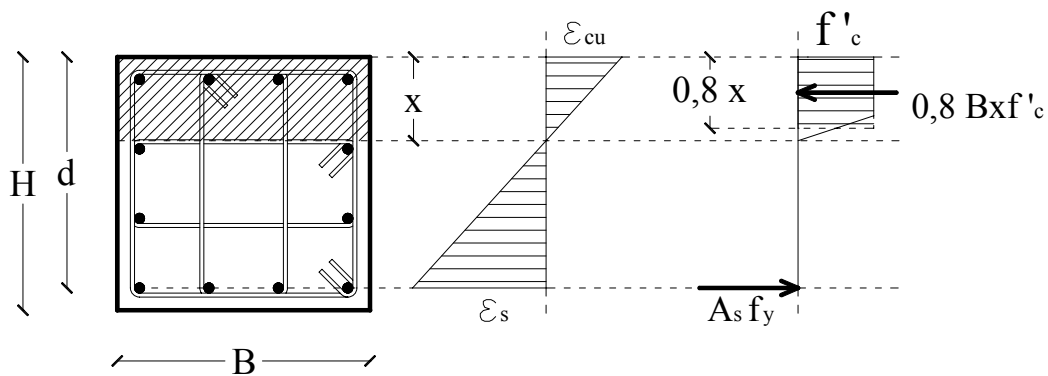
Limite ultimo per la sezione trasversale dei pilastri.
